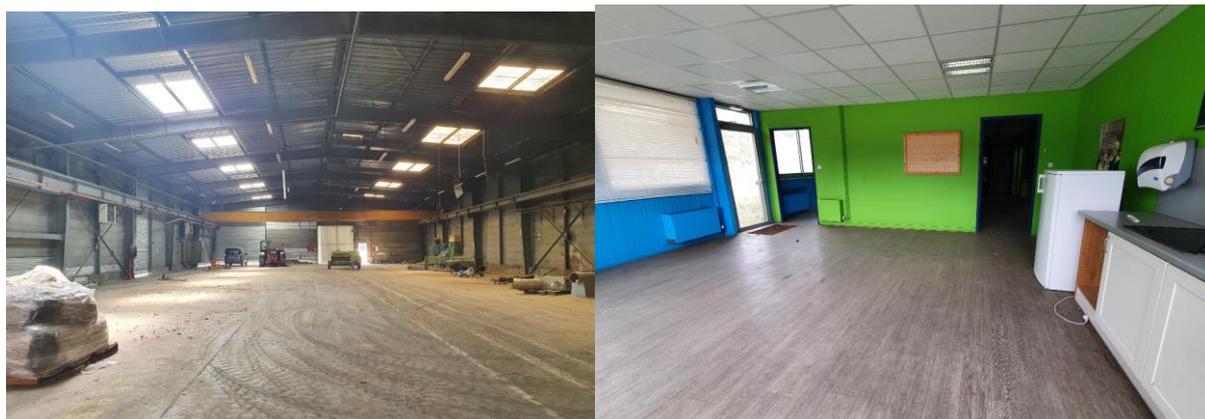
BATIMENT 3 - HANGAR DE STOCKAGE DIVERS ET GARAGE, BUREAUX ET LOCAUX SOCIAUX
